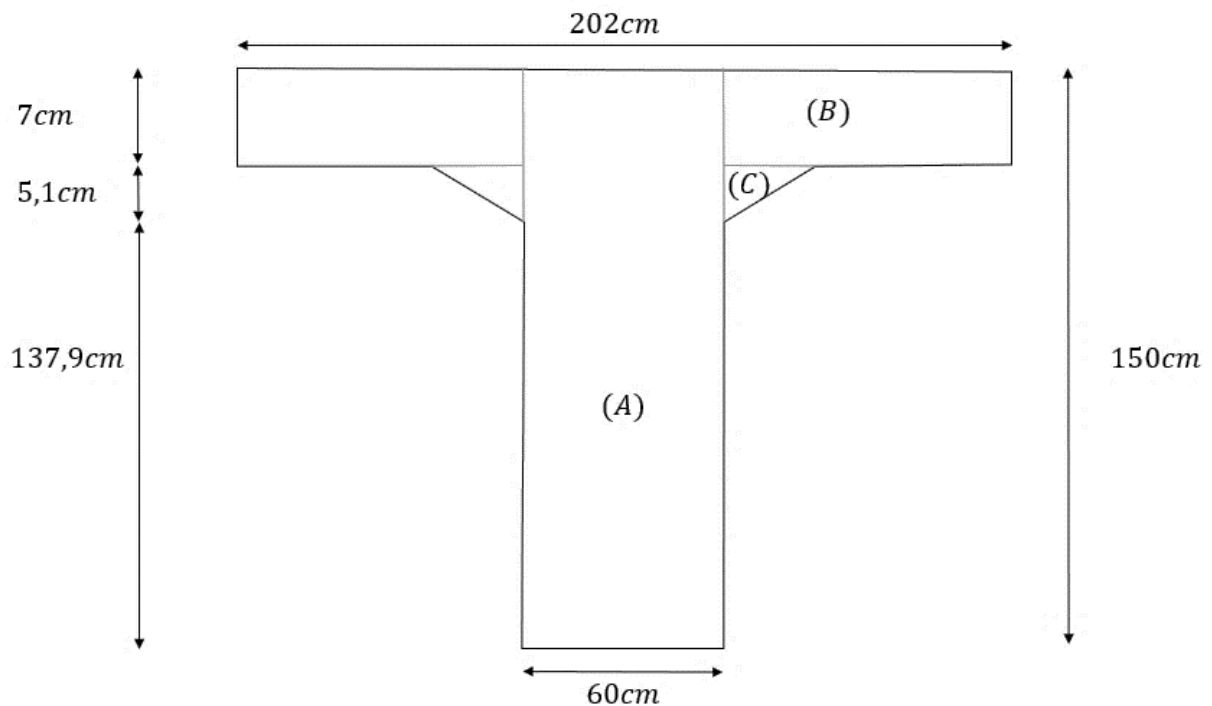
Section de la poutre seule (d'about et fin d'about).
